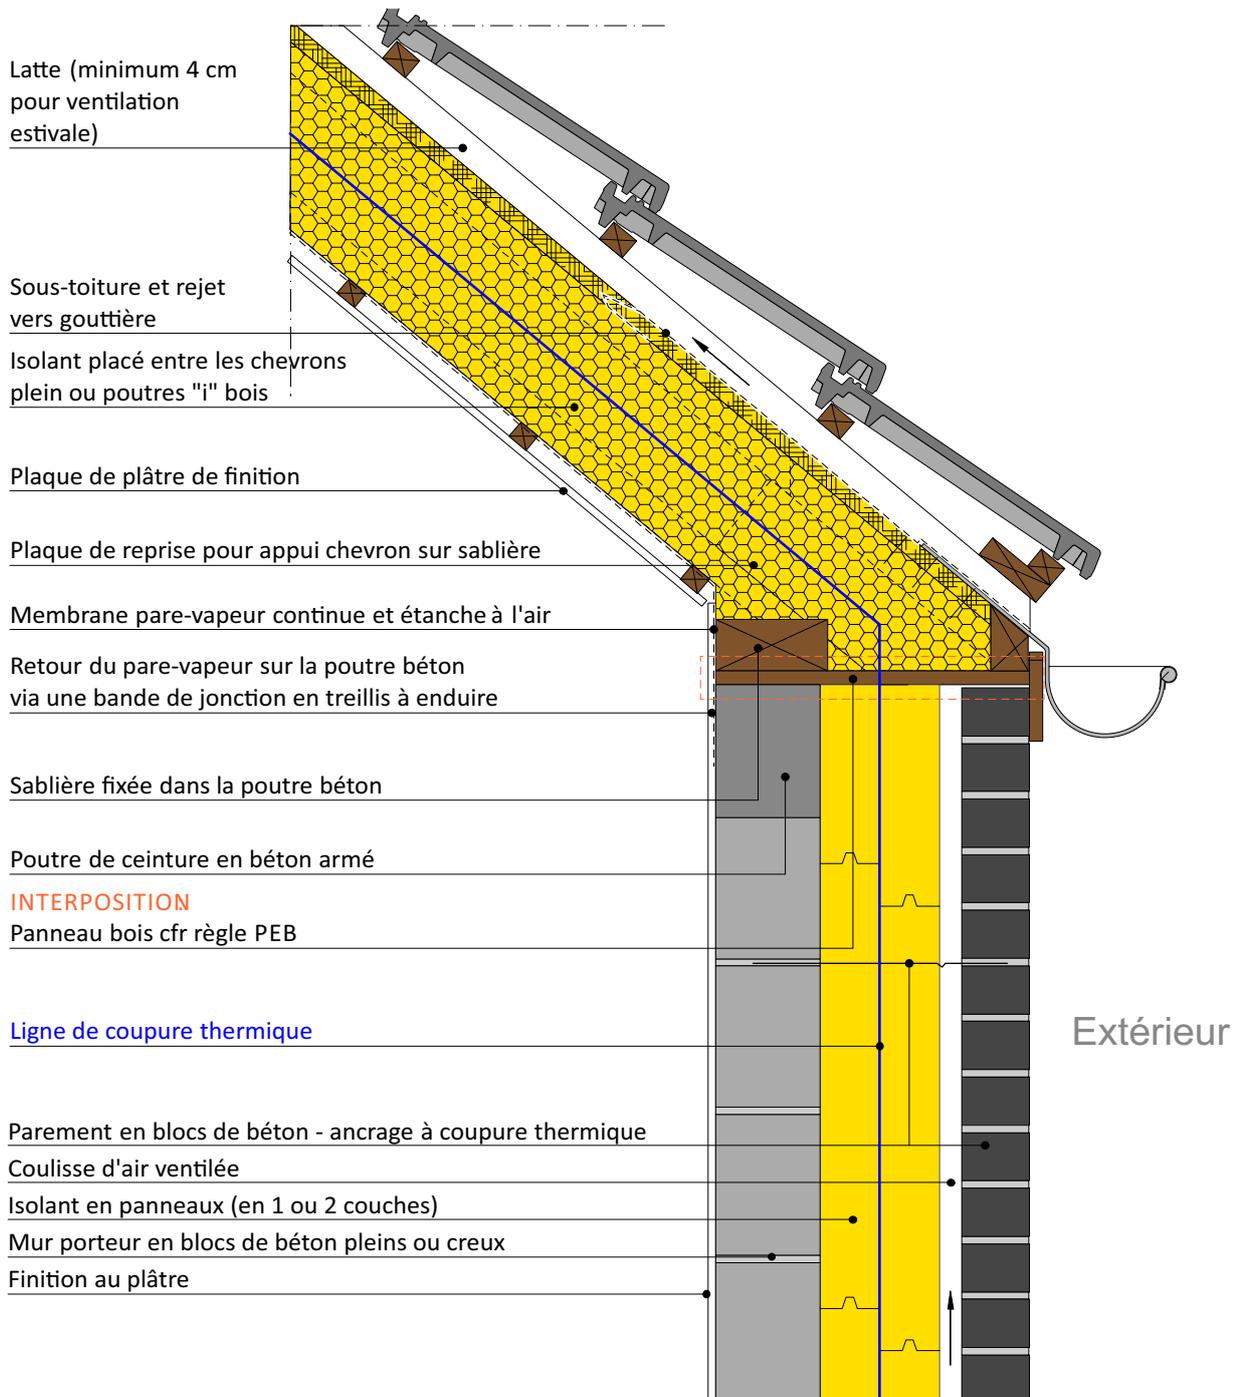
DETAIL EN COUPE	MUR DE FACADE ET TOITURE INCLINEE
